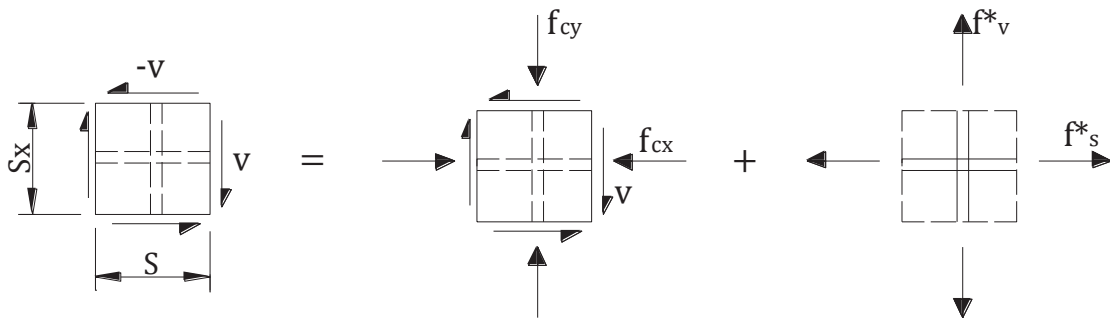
Campo de esfuerzos en el alma de una viga de concreto reforzado sujeta a cortante puro
